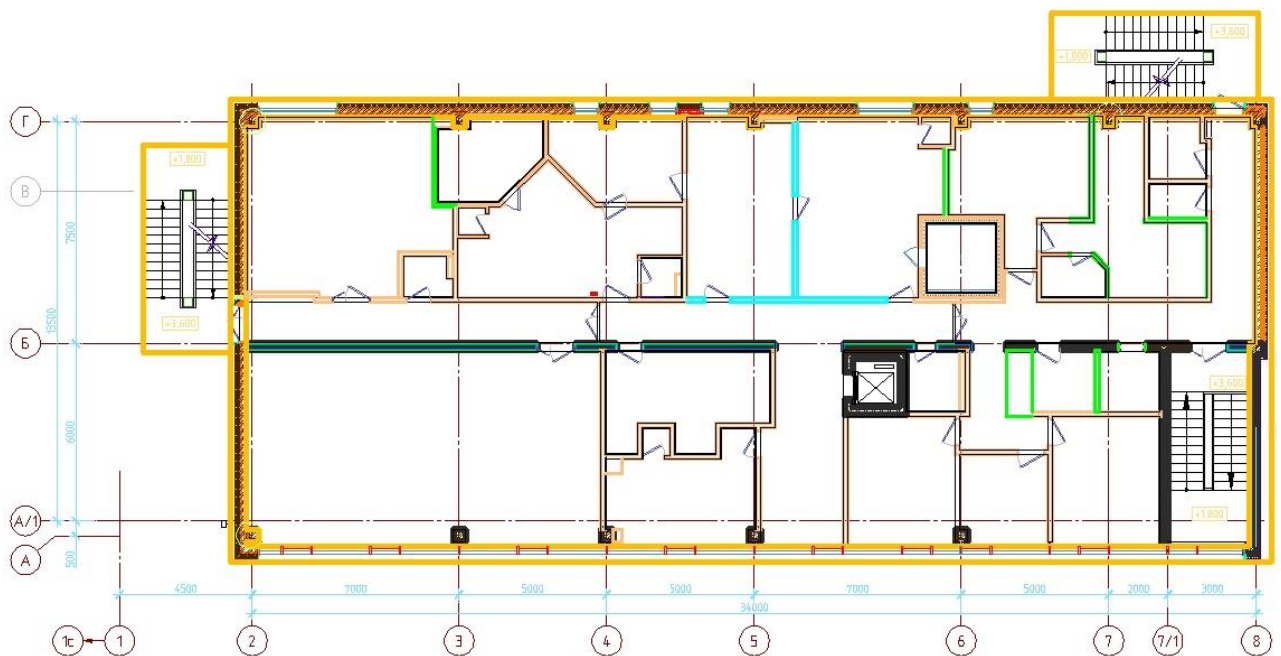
Рассматриваемый участок плиты перекрытия 2-го этажа
